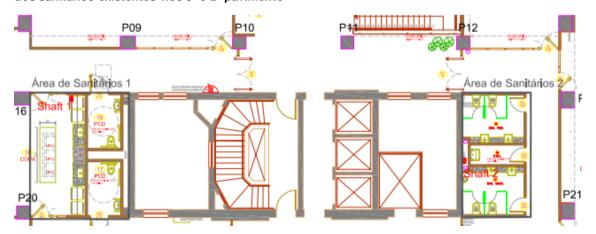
Primeiro Pavimento – Localização das área dos sanitários propostos coincidentes as área dos sanitários existentes nos 3º e 2º pavimento
